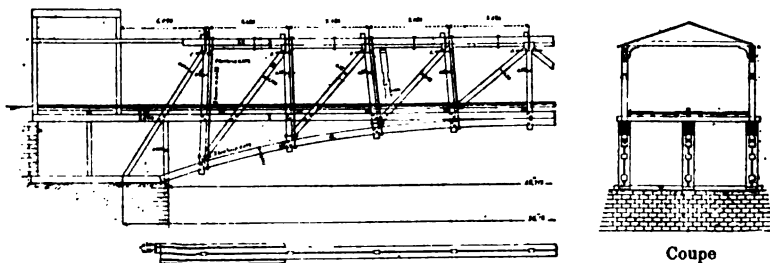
et 10. — Pont sur la Delaware à Easton (demi-élévation).
